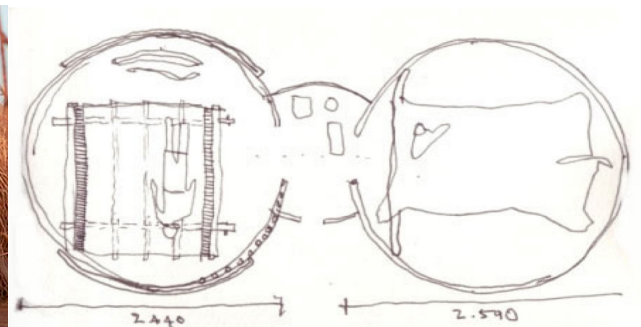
Grundriss eines Familienhauses (links) und eines Gästehauses (rechts) mit Verbindungsteil zwischen beiden in Ali Adayto (vgl. Abb. 35/Foto)
